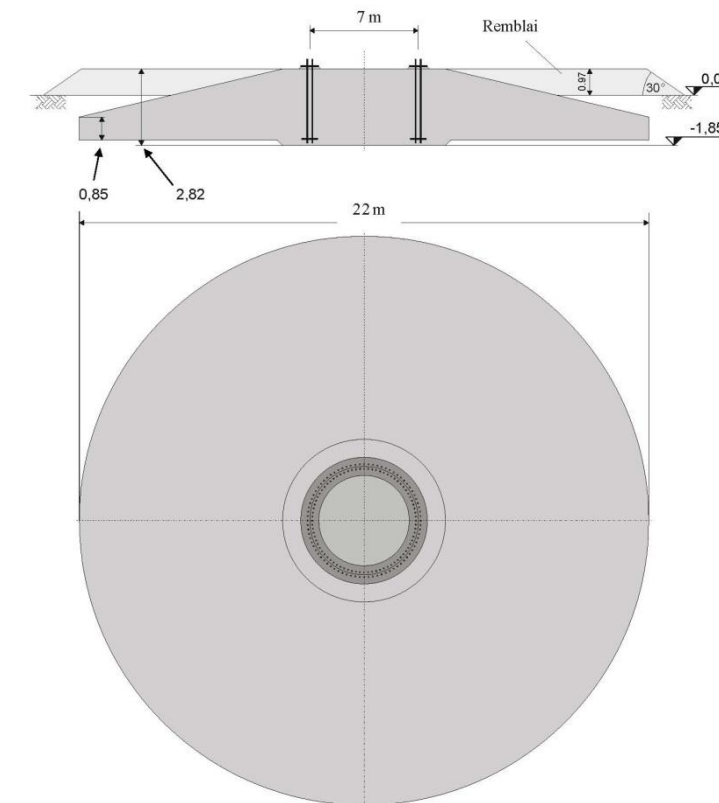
Différentes vues sur les fondations (source : Nordex, 2014)
